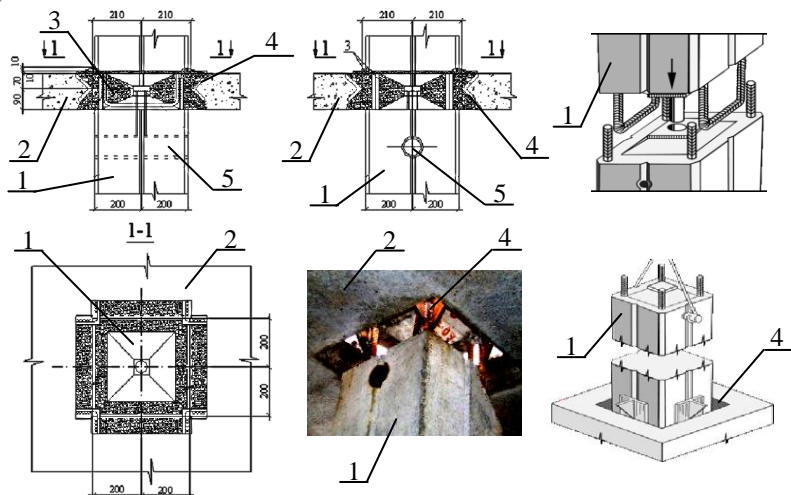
Схемы соединения надколонной плиты с колонной: 1 – колонна; 2 – плита (вид снизу); 3 – бетон; 4 – стальная обойма; 5 – монтажное отверстие
